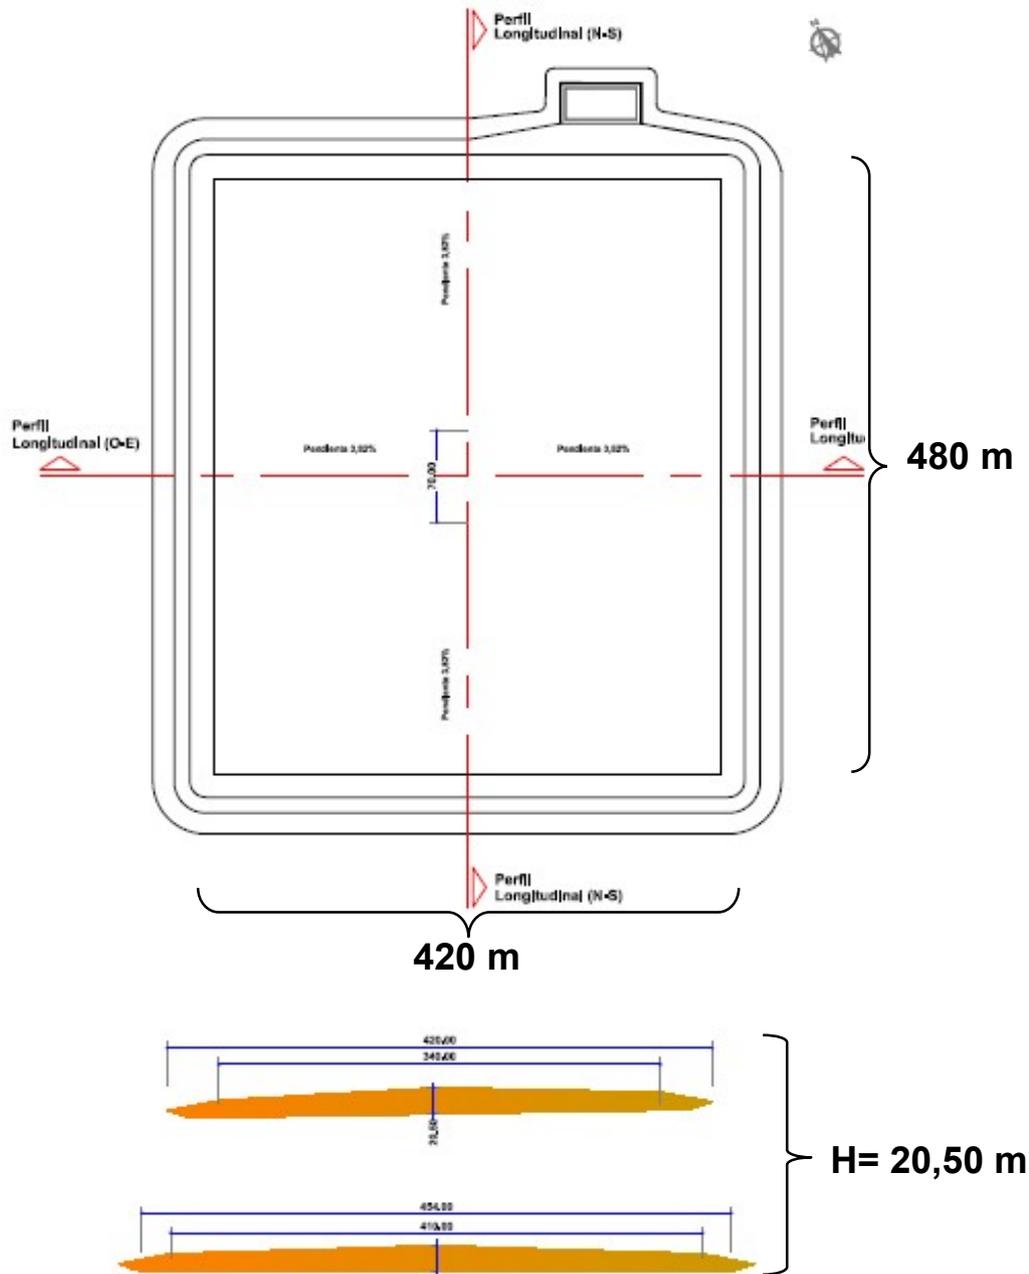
Croquis Planta de Módulo de disposición final y Cortes Esquemáticos
